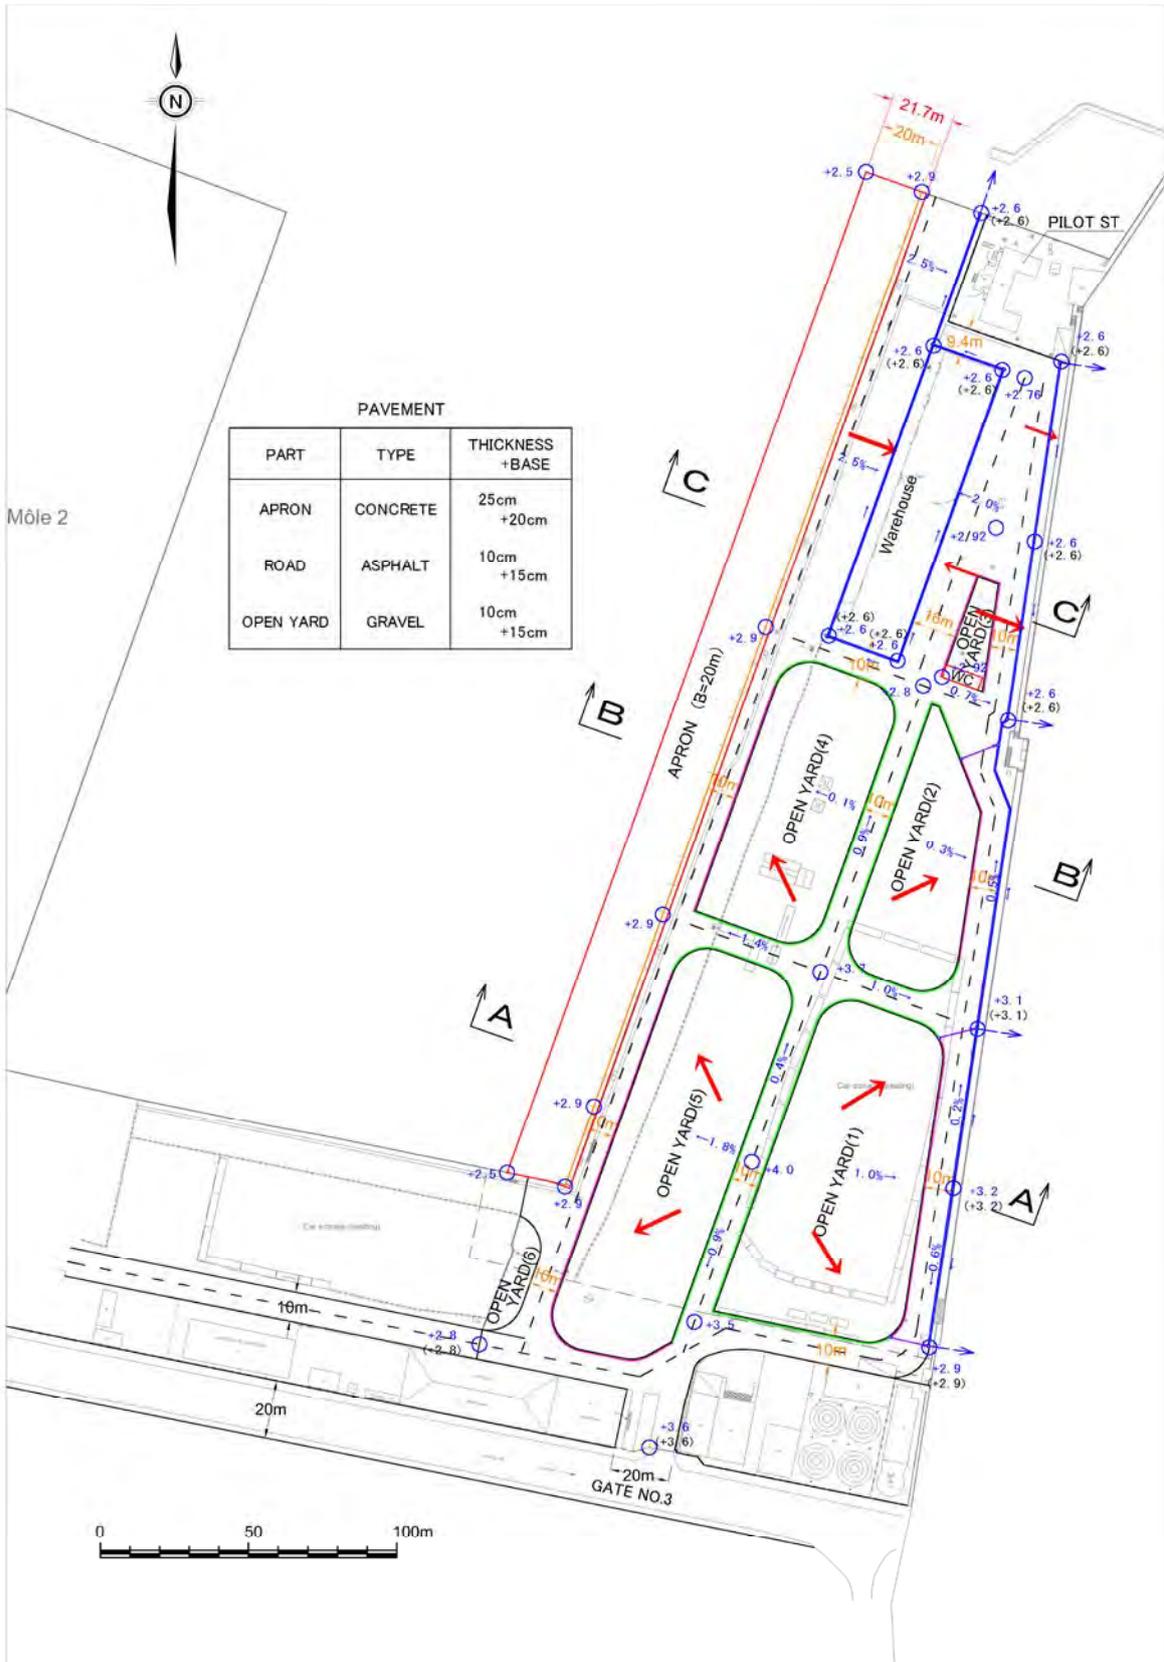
Plan d'implantation de la route, des terre-pleins et de drainage et caractéristiques du revêtement
